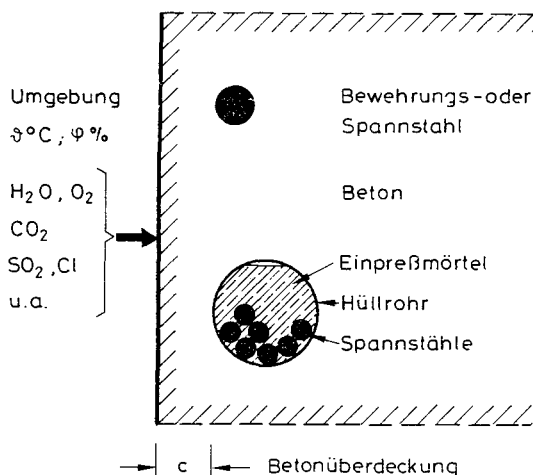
Stahl in Beton und Einpreßmörtel sowie äußerer Angriff
